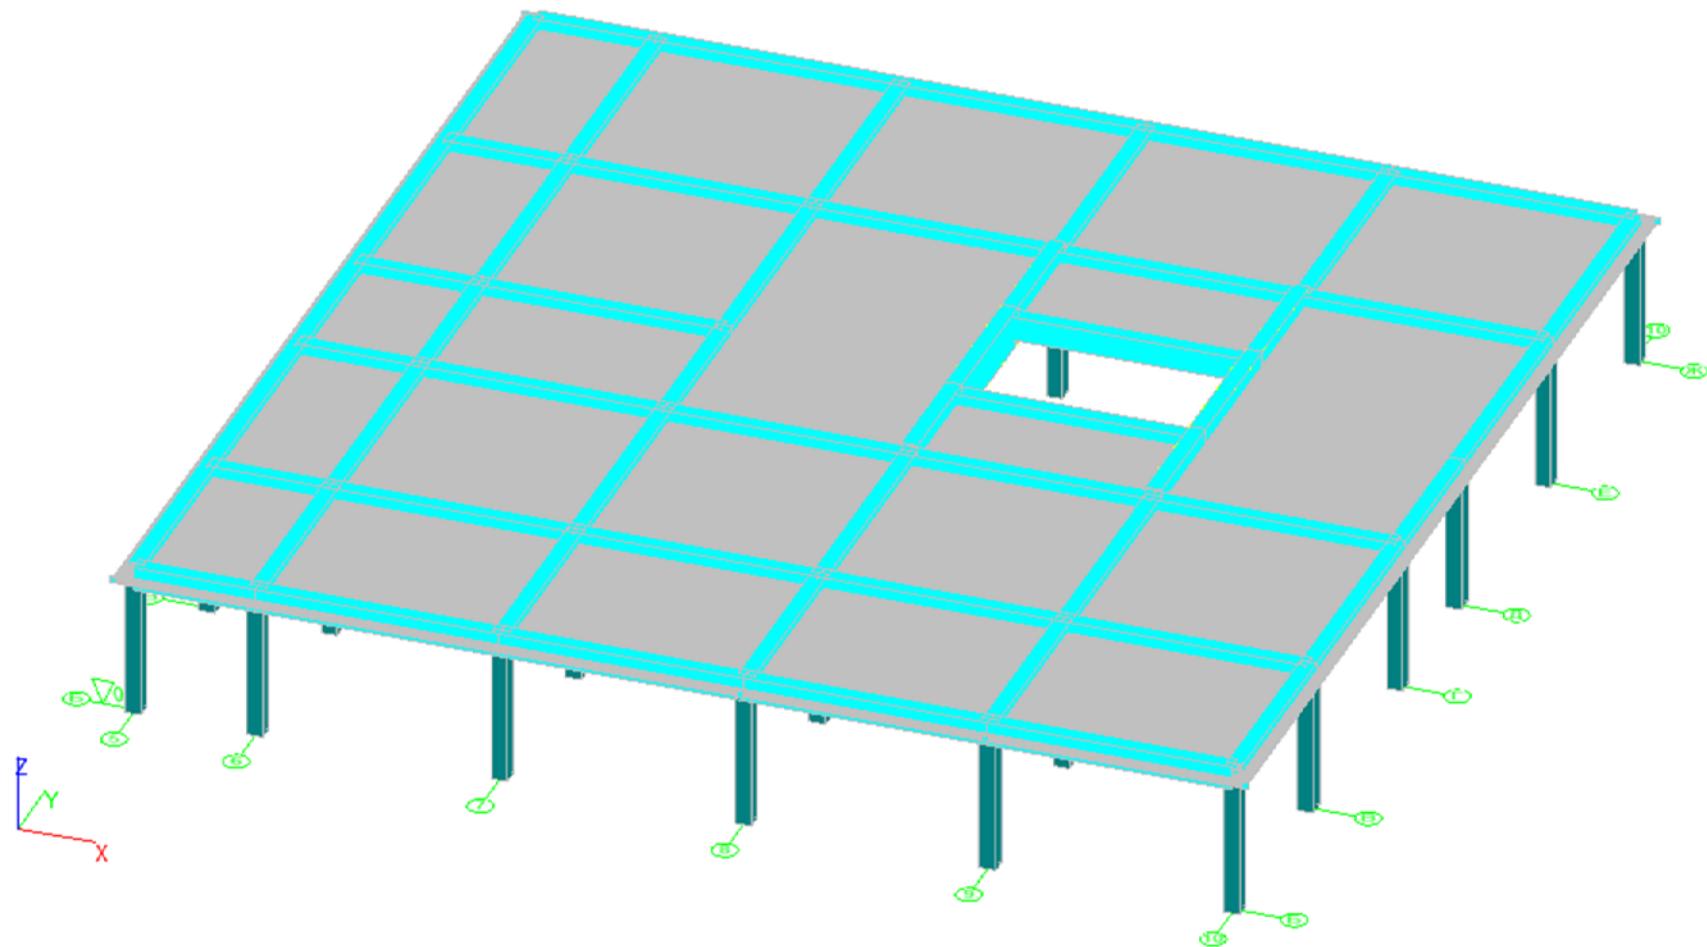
Укрупненная схема междуэтажного перекрытия
